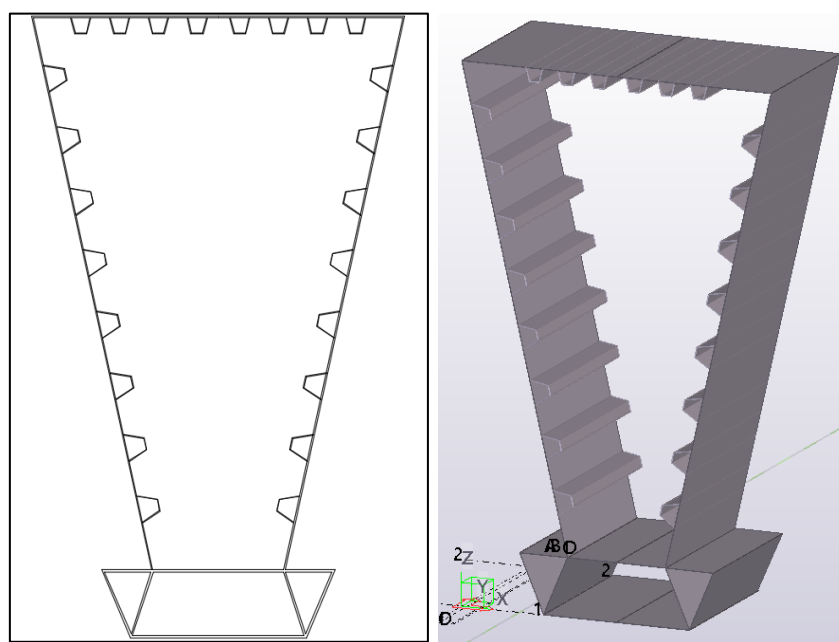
Secção transversal da viga/ Modelo 3D.
